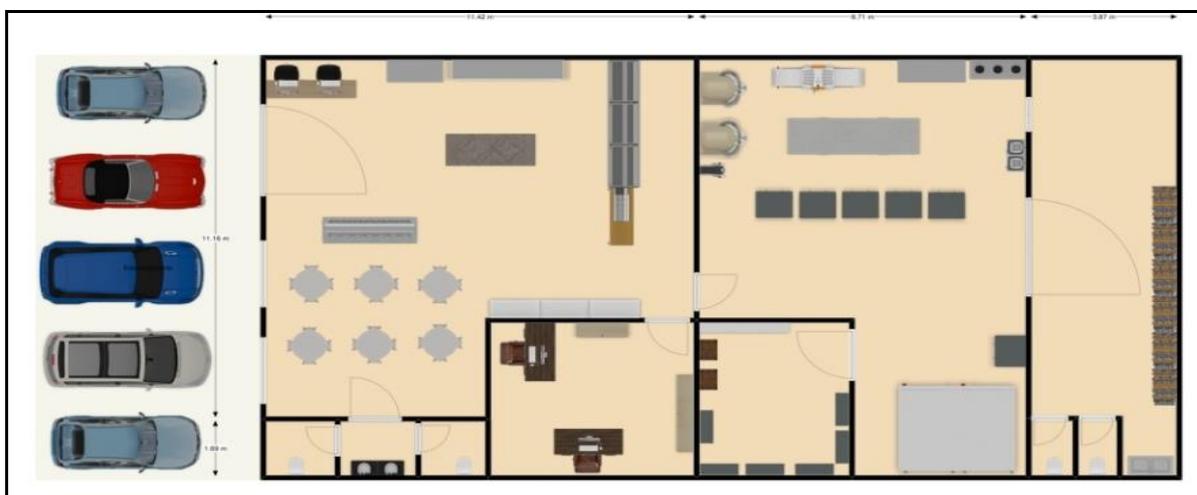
Planta baixa – Área de produção, estoque, área externa wc
